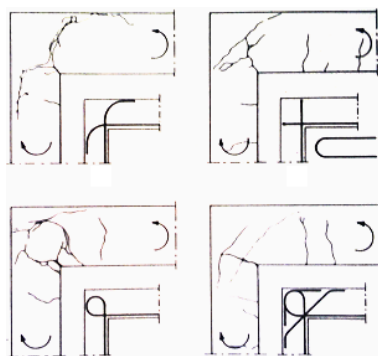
Opening joint*; Aspecto das fendas em nós de pórticos para diferentes tipos de armadura – adoptado de Leonhardt (1978).
